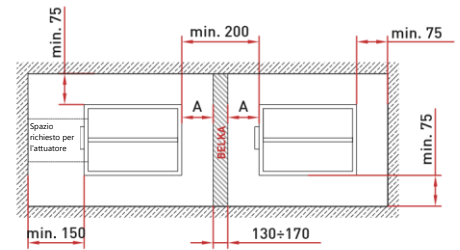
Distanza richiesta tra le serrande KWP-O installate singolarmente.
